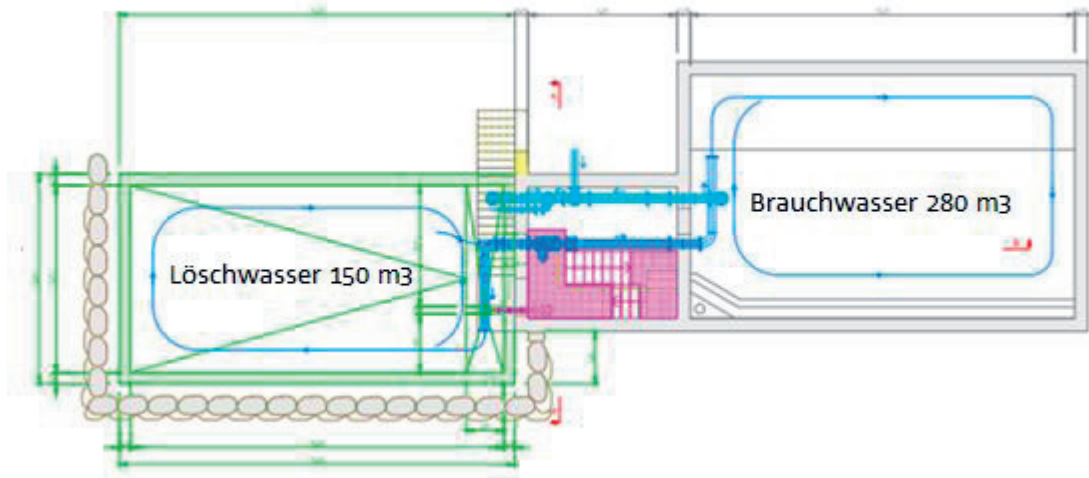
Grundriss Reservoir Sitli (Neubau in grün)
